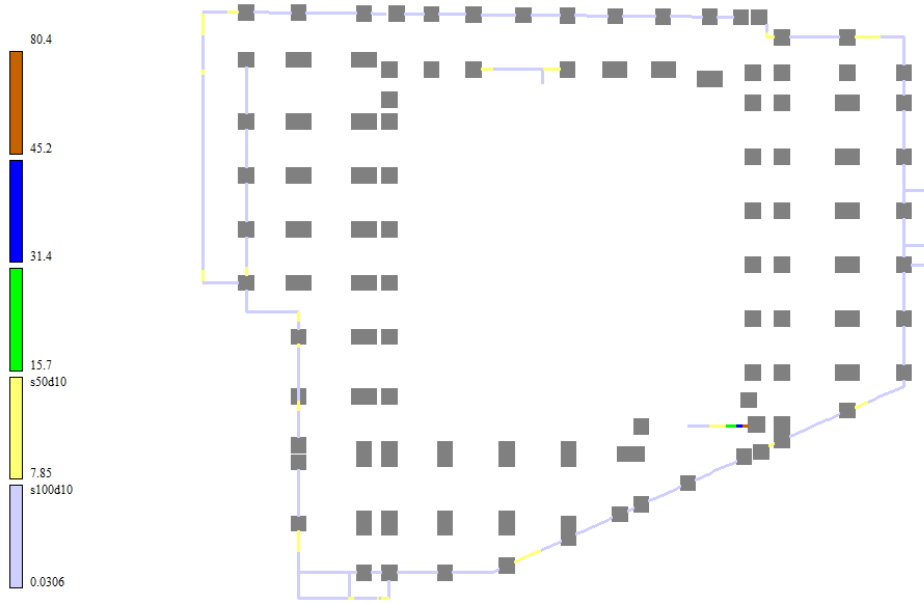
Площадь арматуры AU3 AU4 AS2 в балках покрытия
